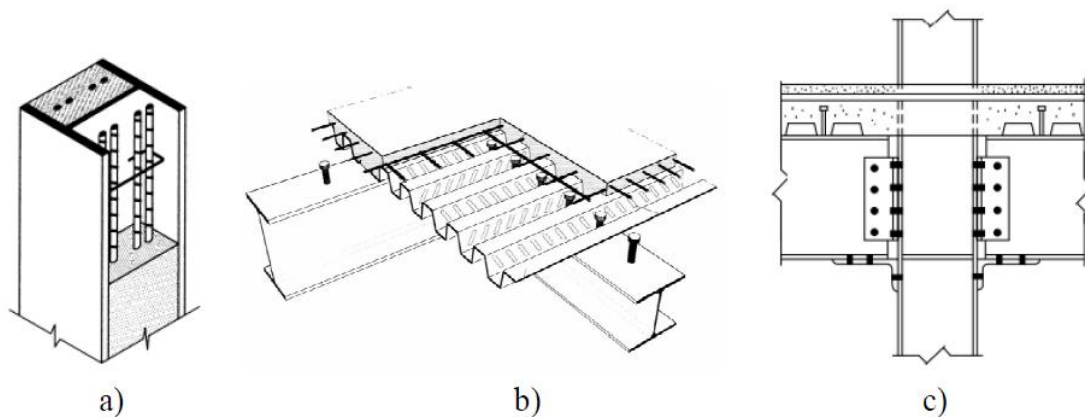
Exemplos de elementos estruturais mistos: a) Pilar Misto, b) Viga e lajes mistas, c) Ligação mista.
